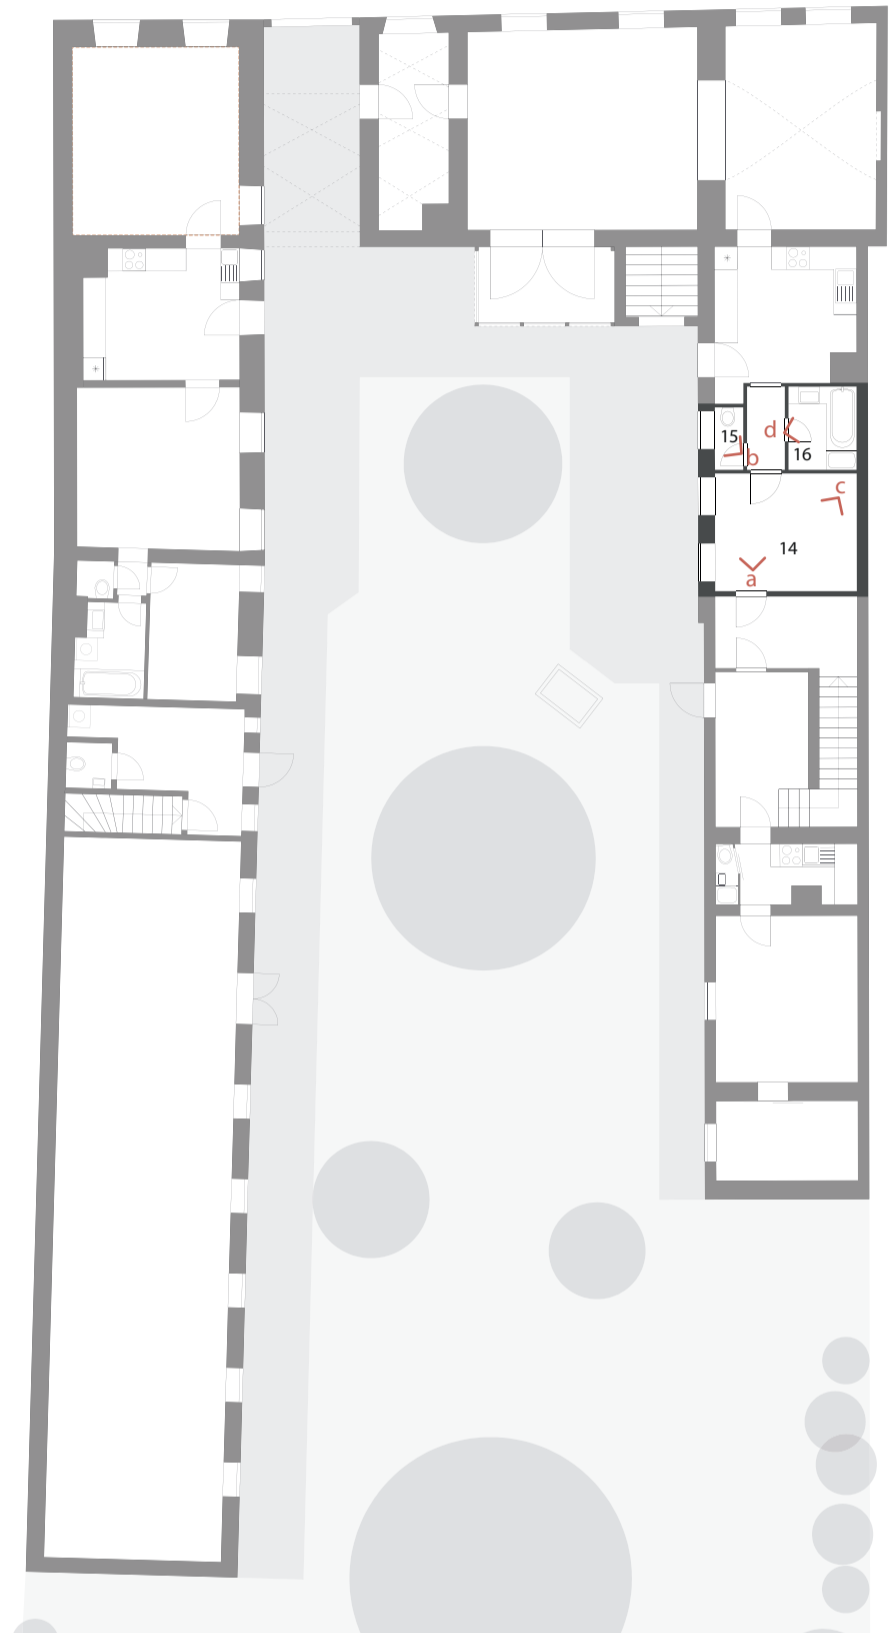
Grundriss Erdgeschoß | M 1:200 | Raum 14, 15, 16
